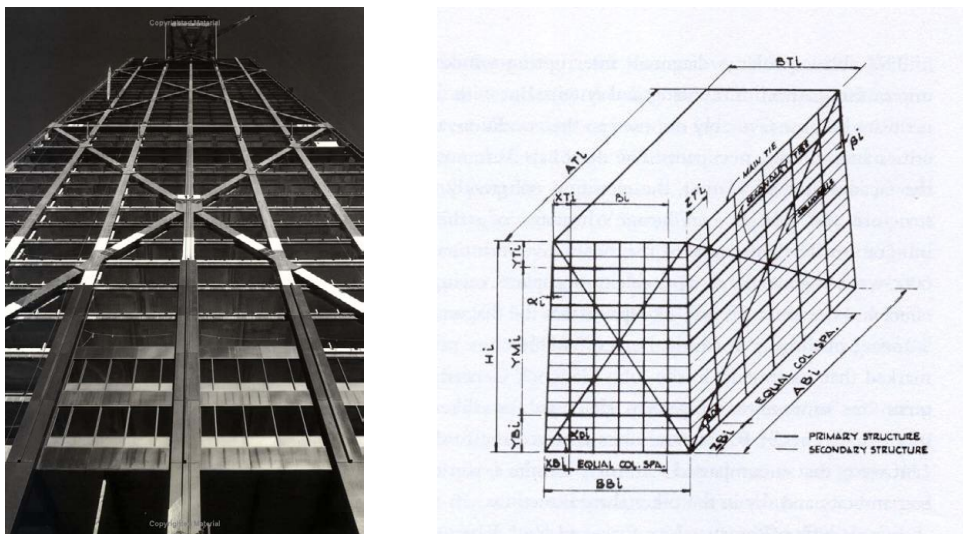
John Hancock Building. Estructura en fachada. Esquema parcial de estructura.
